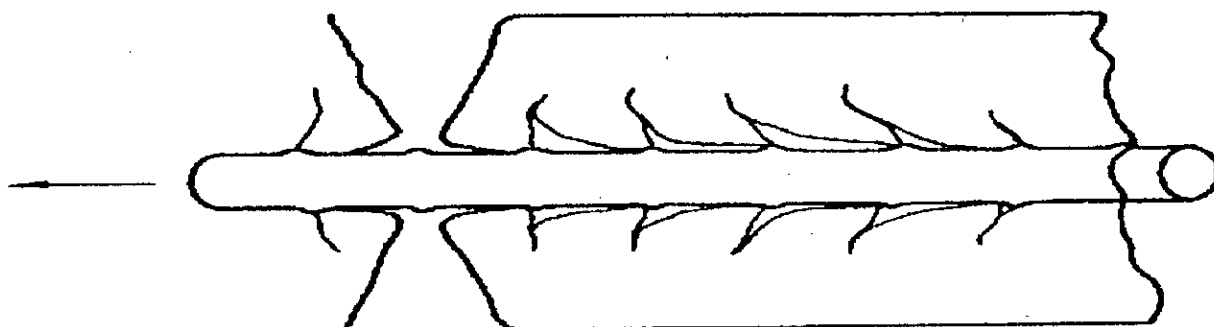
Schéma de la fissuration au voisinage d'une barre à haute adhérence.
